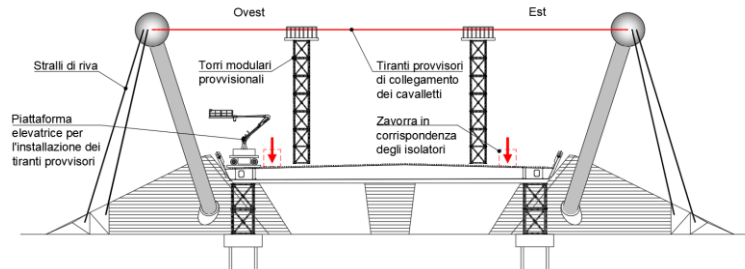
Disposizione delle zavorre e tesatura dei tiranti provvisori
